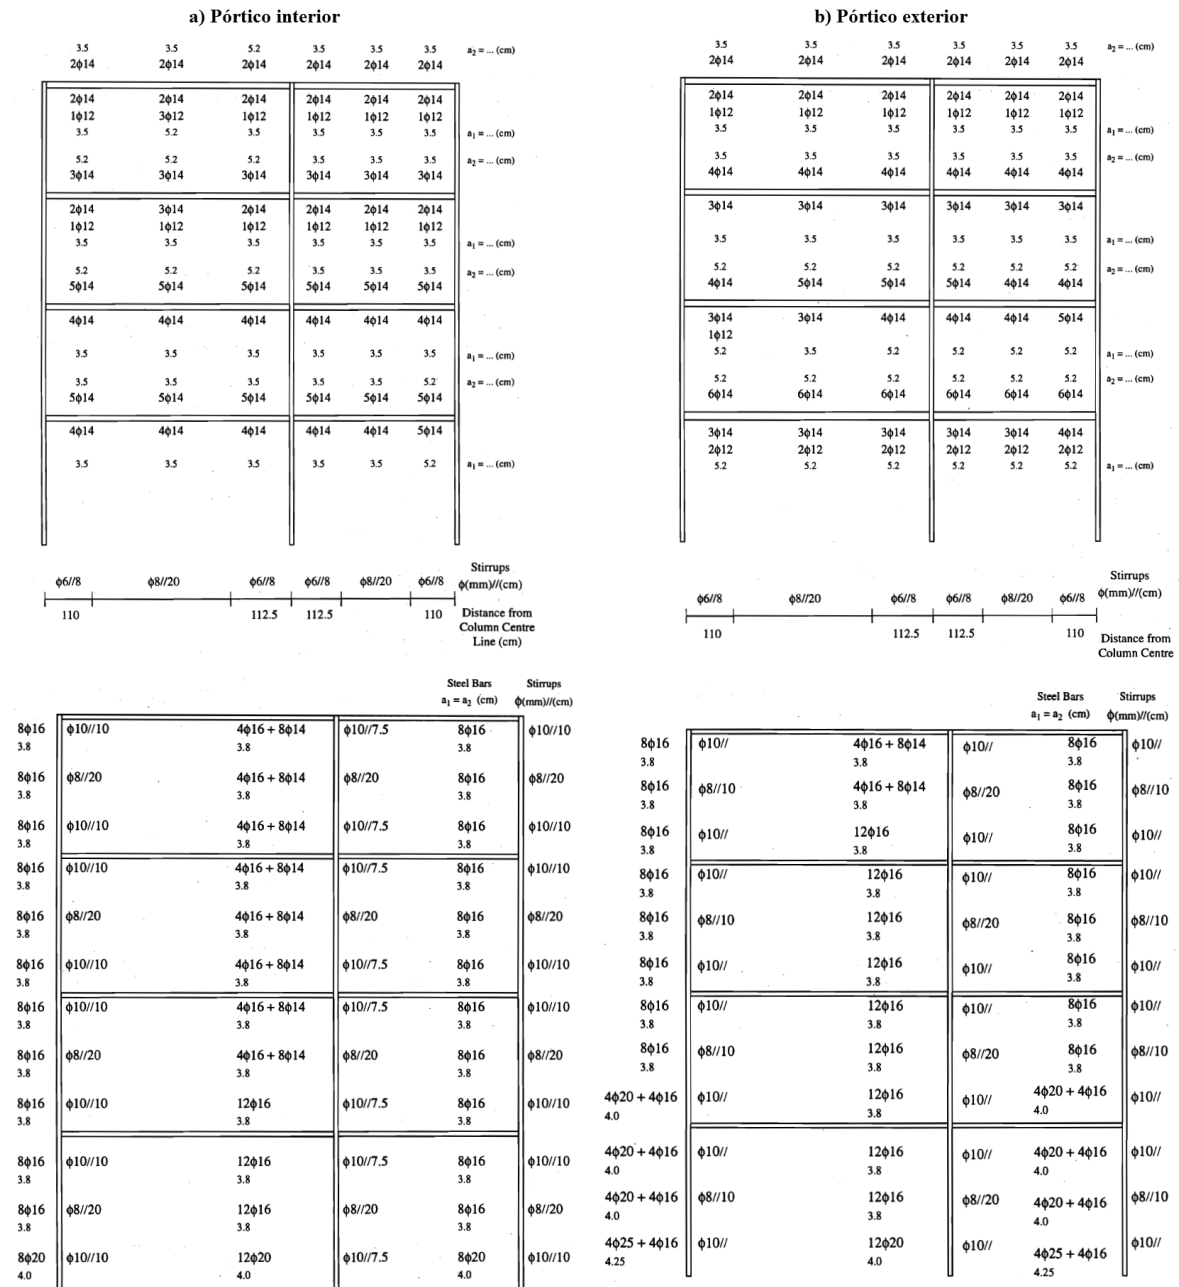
Disposição das armaduras nas vigas (em cima) e dos pilares (em baixo) (adaptado de Negro et al. (1994)).
